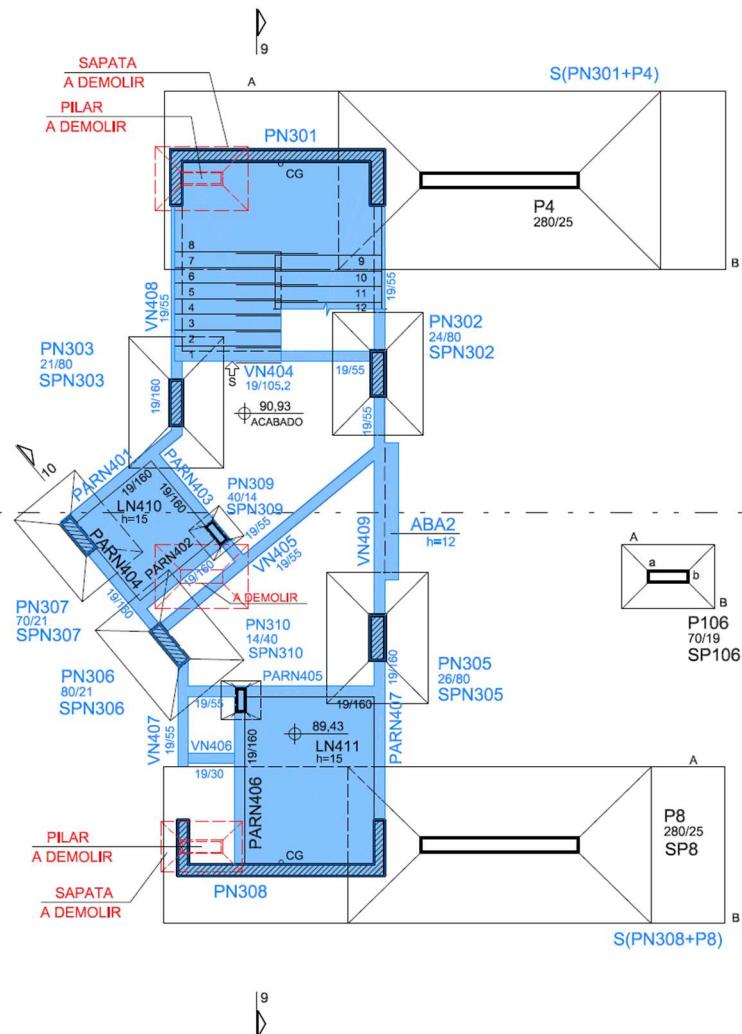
Planta com projeto de estrutura atualizado por meio do reforço estrutural.
